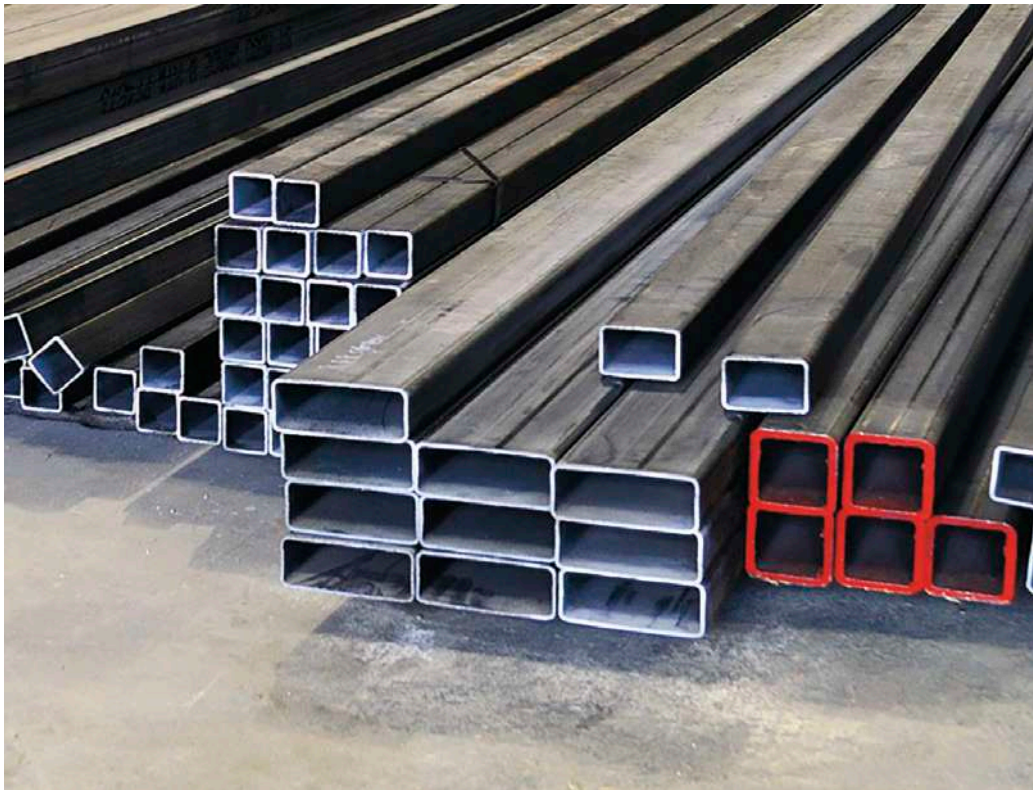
Сварные строительные металлоконструкции коробчатого типа из толстолистового проката
